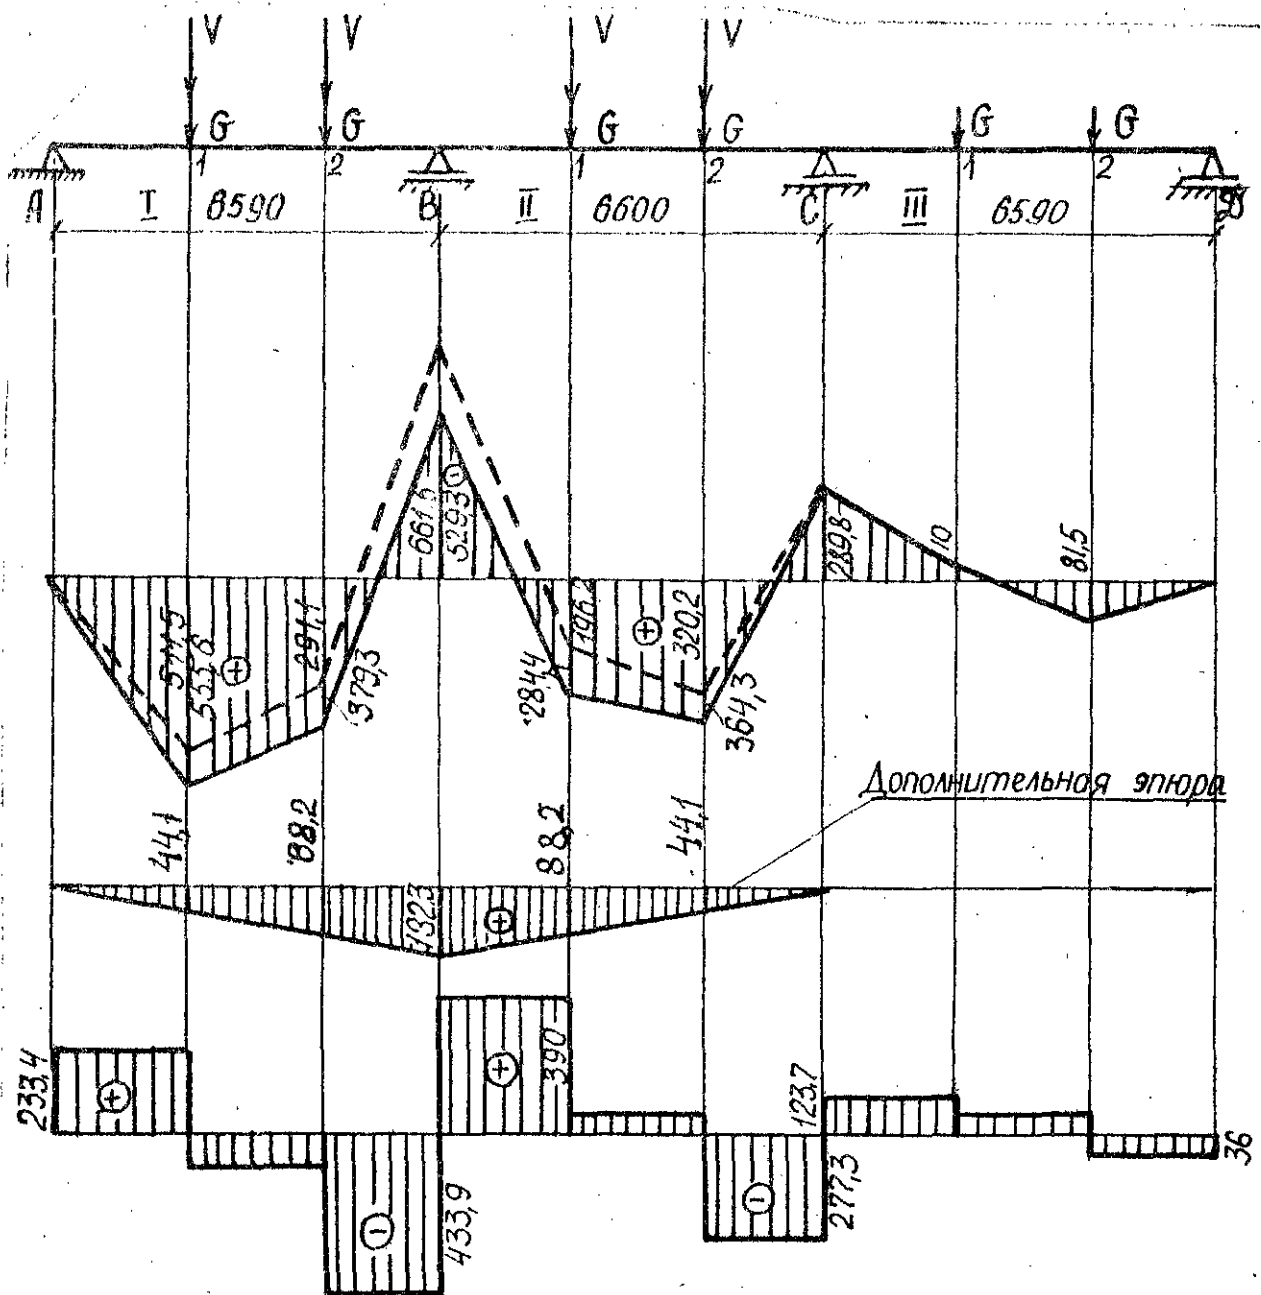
Расчетная схема, эпюры M и Q при 3-й комбинации нагрузок
